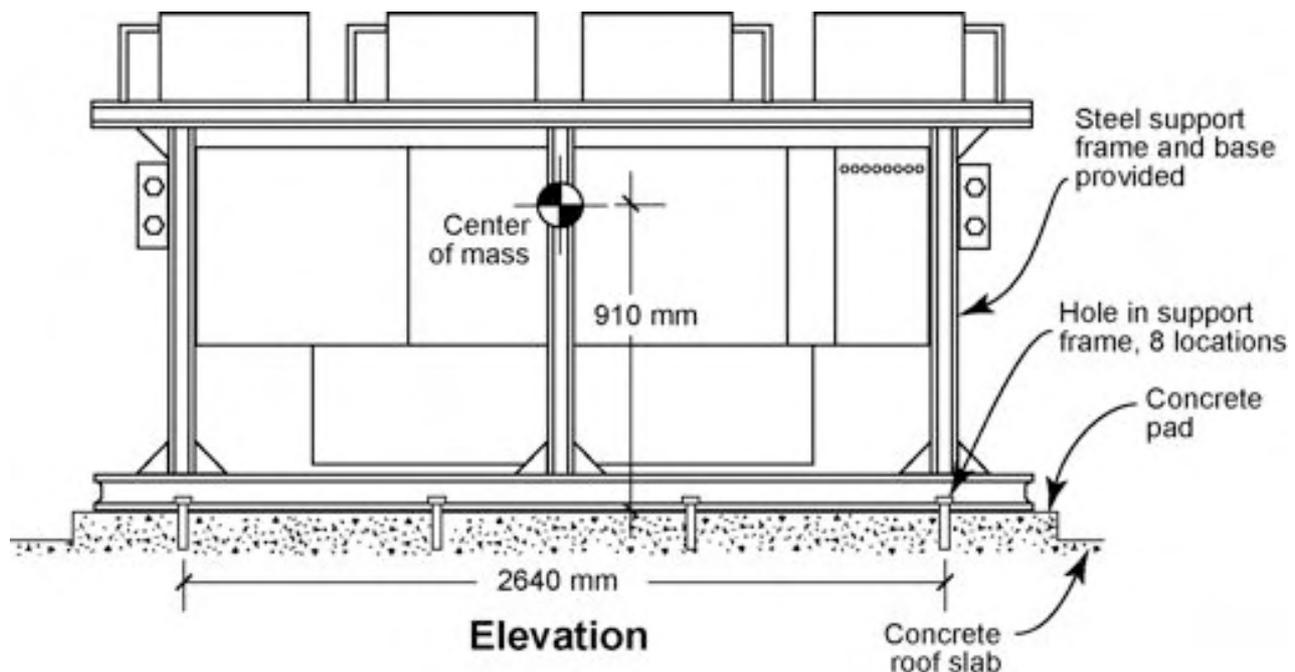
Progetto dell'ancoraggio dell'unità di raffreddamento trattata nell'esempio A.
